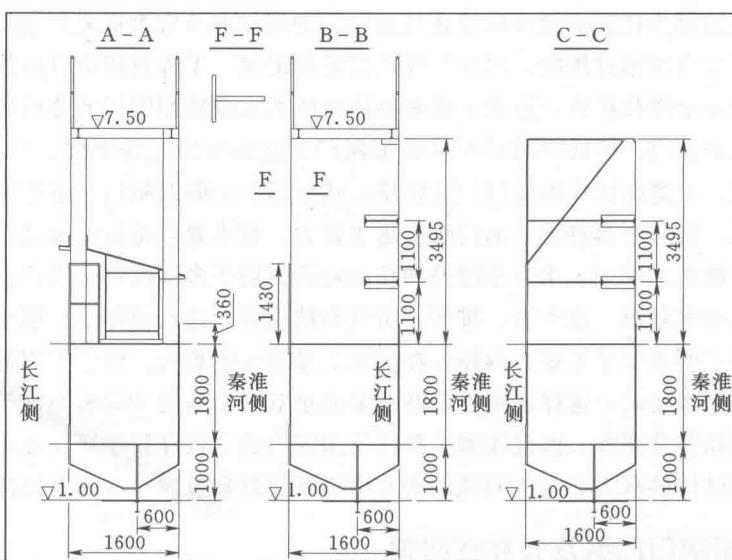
闸门断面布置图 (高程单位: m; 尺寸单位: mm)
